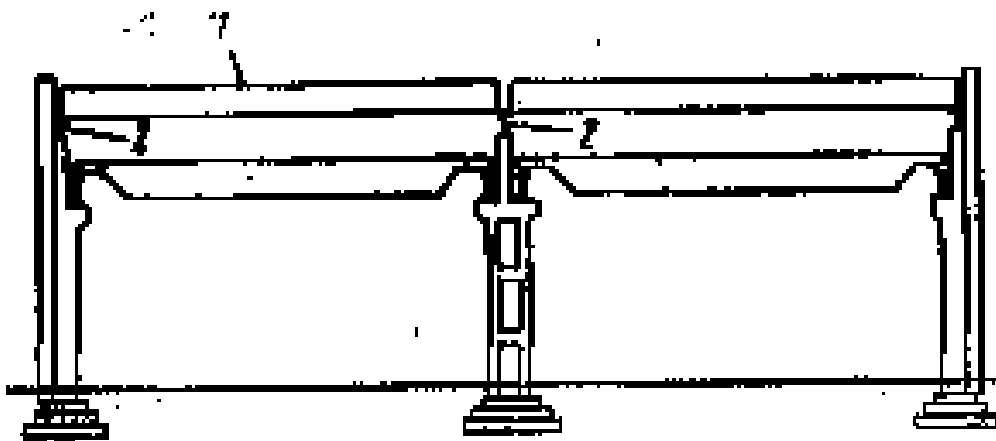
Одноэтажное промышленное здания с плоским покрытием:
